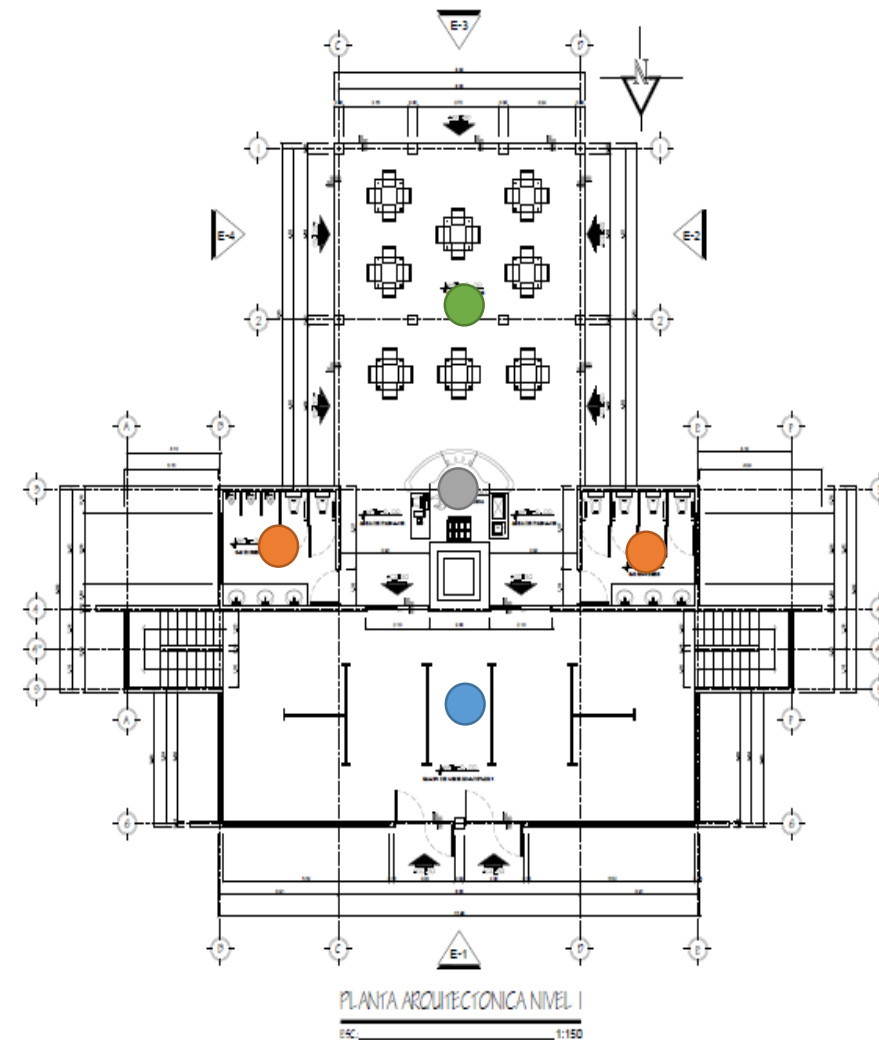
Planta arquitectónica Rancho Cantabria. Finca Las Delicias
